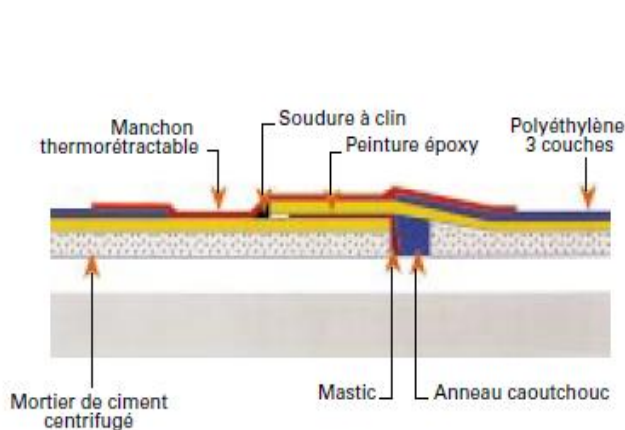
Joint à emboîtement et soudure (Tirée du document Europepe)
